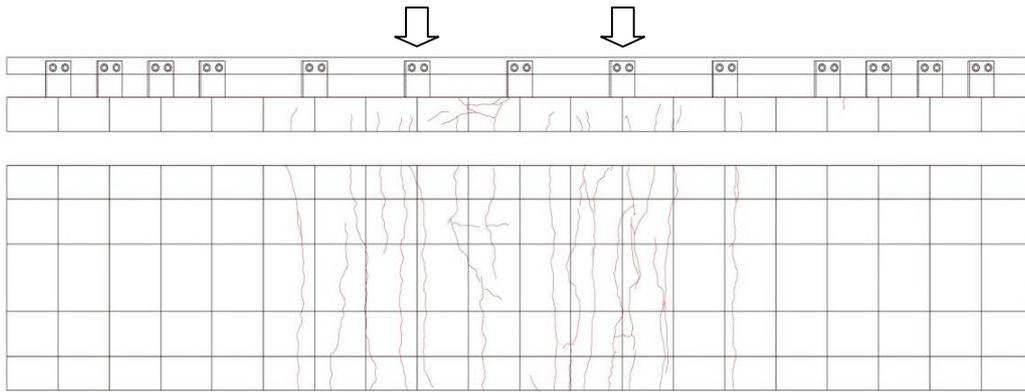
ひび割れ図(ケース 1 実験終了時)
